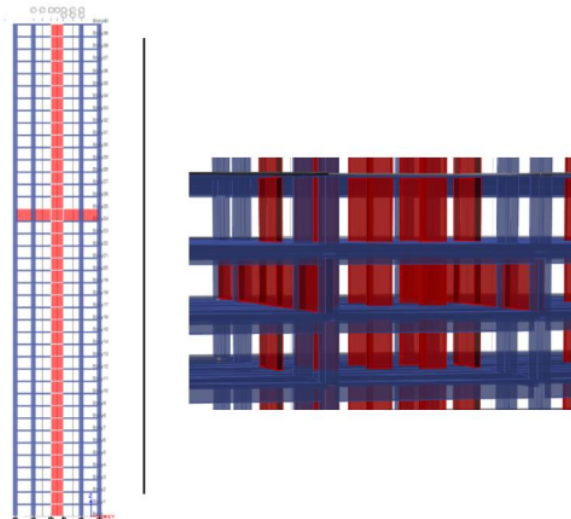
Elevación y detalle del modelo con outriggers en el piso 25
